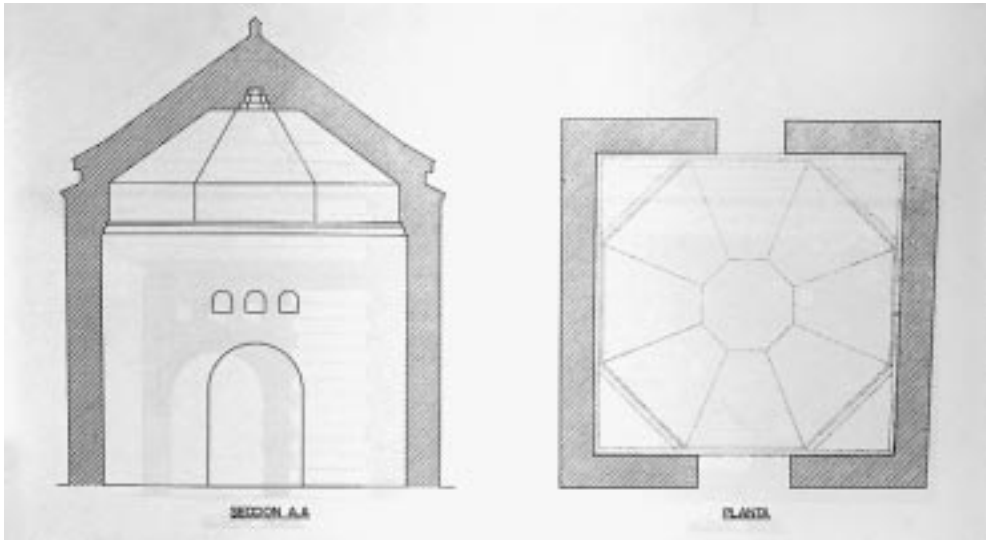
Toledo. Salón de don Diego (planta y alzado).
